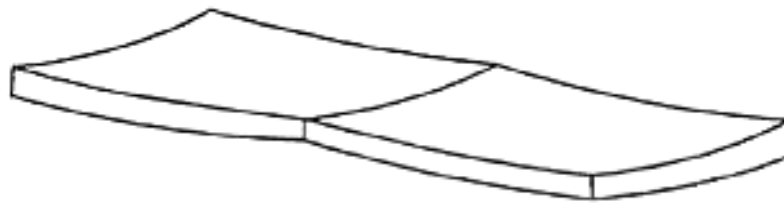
Fenómeno de “Curling” onde existe levantamento e encurvamento dos bordos de um painel
